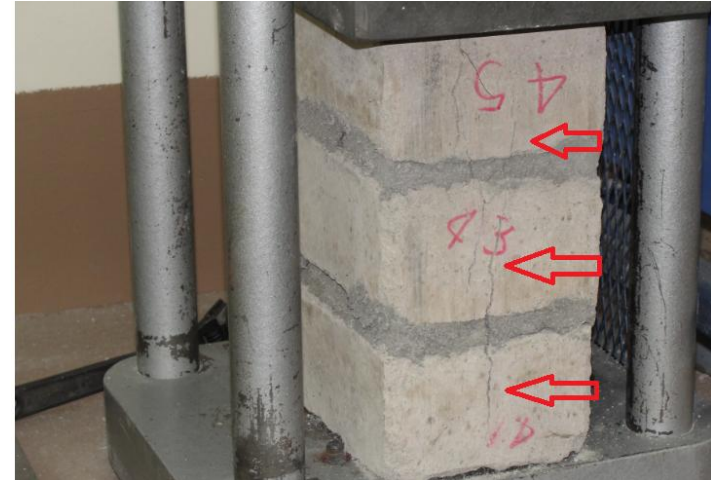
Avance de fisuración en murete ensayado. Fuente: Autor.
